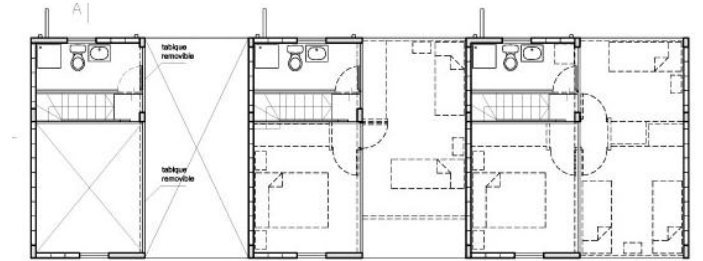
Planta segundo nivel (Duplex primer nivel)
